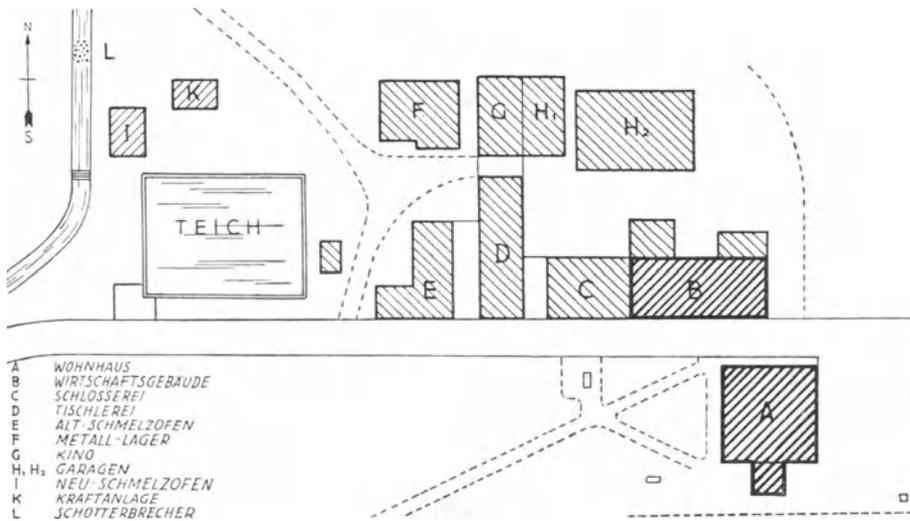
Grundriß der Anlage auf Rochuspunt.
